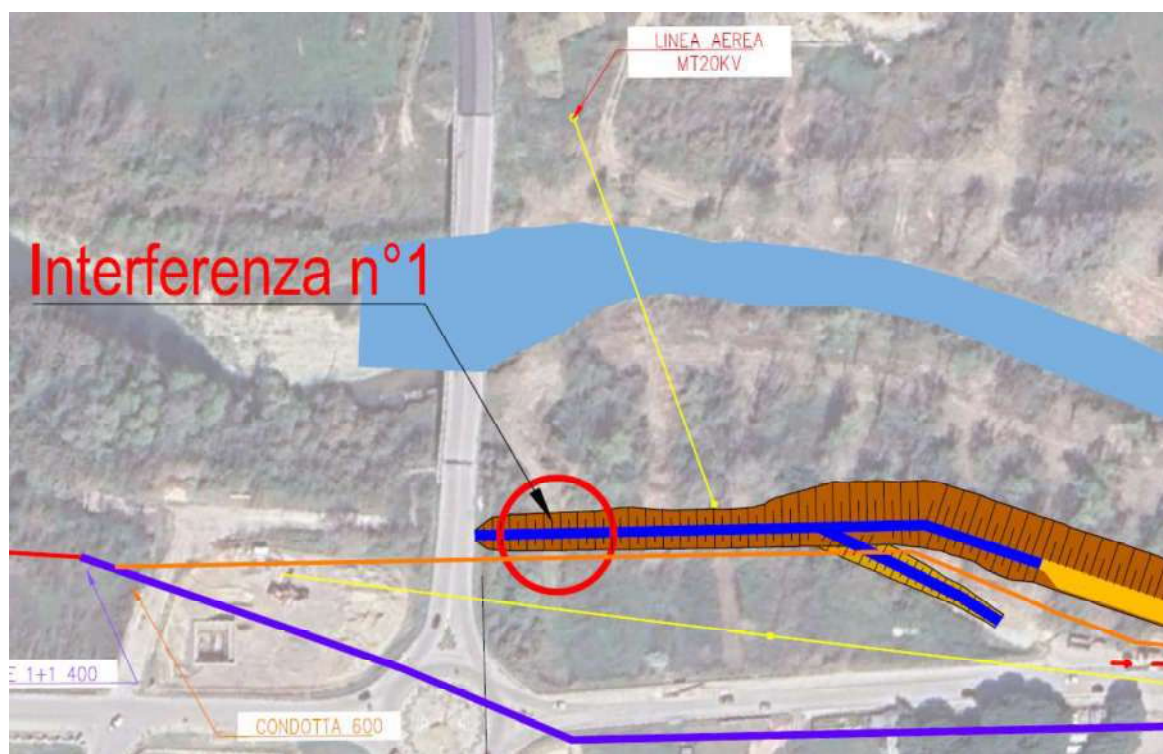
Stralcio planimetrico con ubicazione dell'interferenza tra l'argine di progetto e lo scarico del Fosso Foreste, appena a valle del ponte
